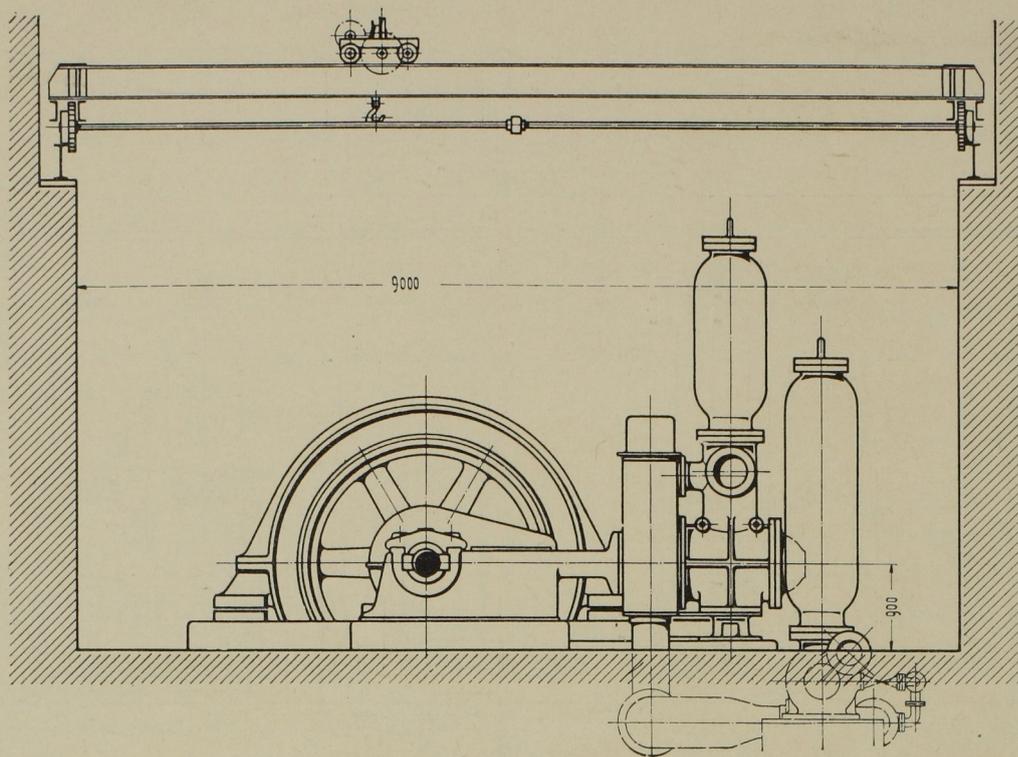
Querschnitt durch den Maschinenraum. Massst. 1:75.
